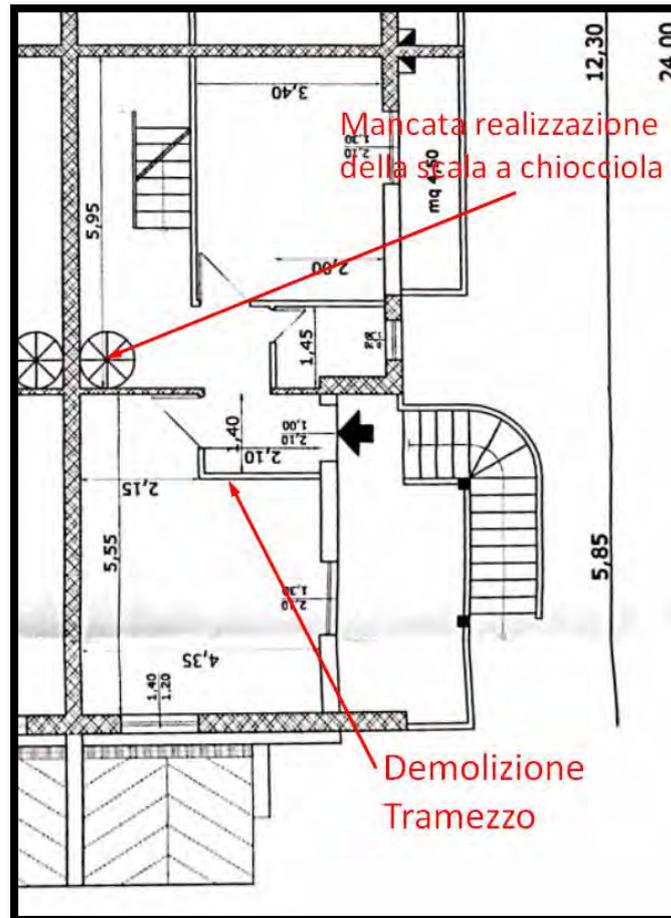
Pianta piano primo allegata alla CILA prat. n. 294/2011
